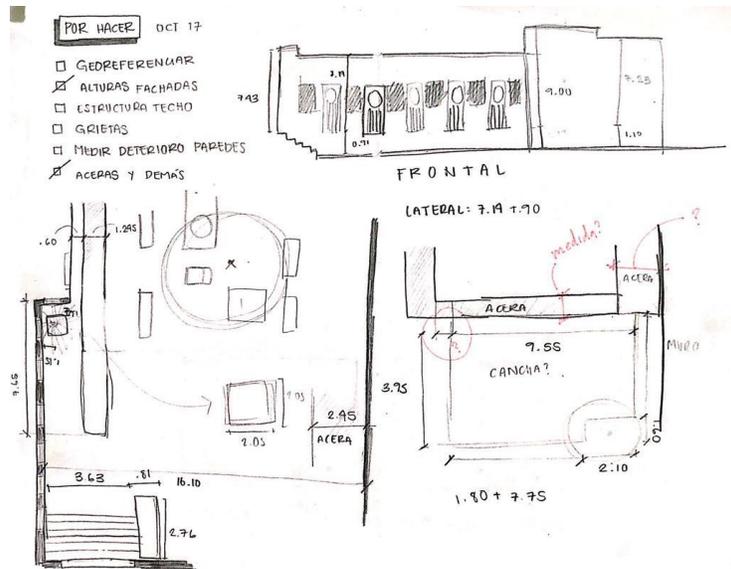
Notas del levantamiento de Fachadas y áreas recreativas
